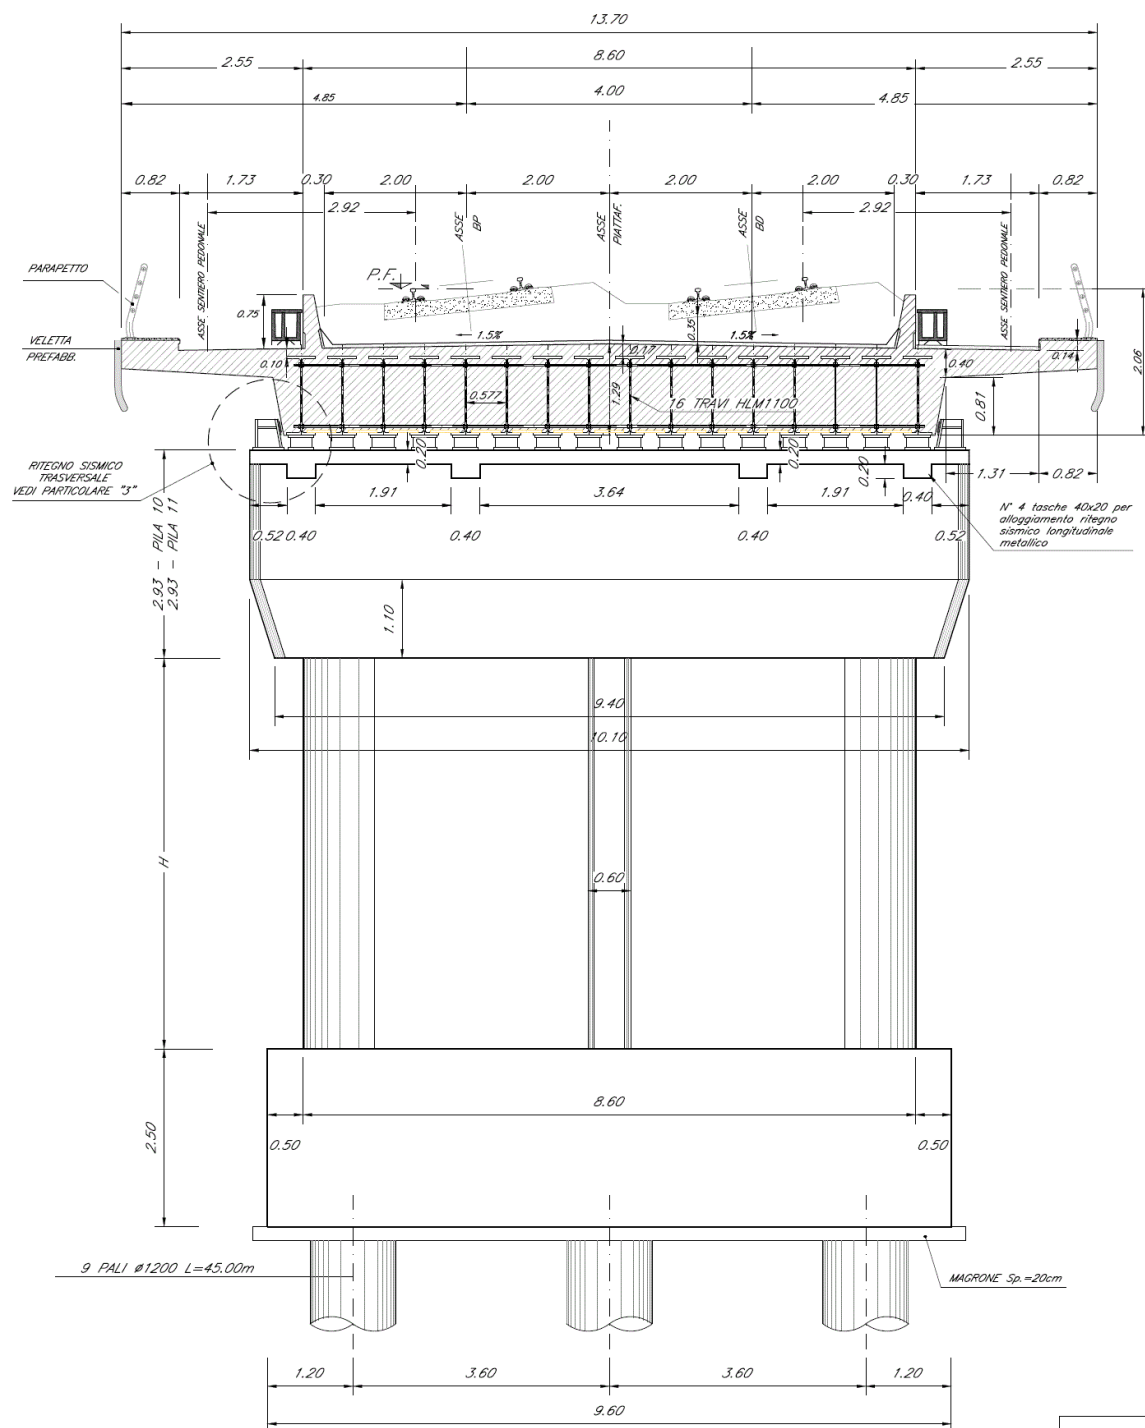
Pila, prospetto frontale – Impalcato con travi incorporate. [m]
